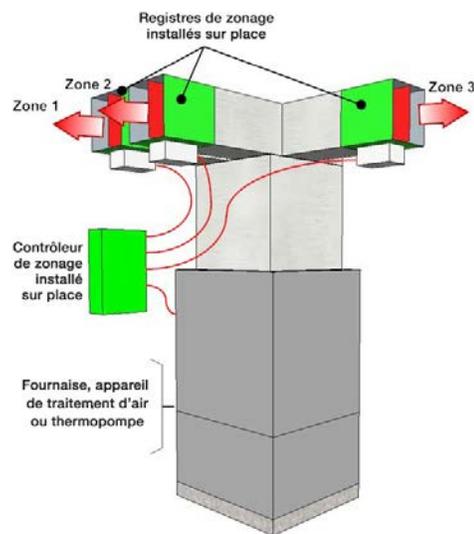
Exemple d'un système de chauffage zoné assemblé sur place
